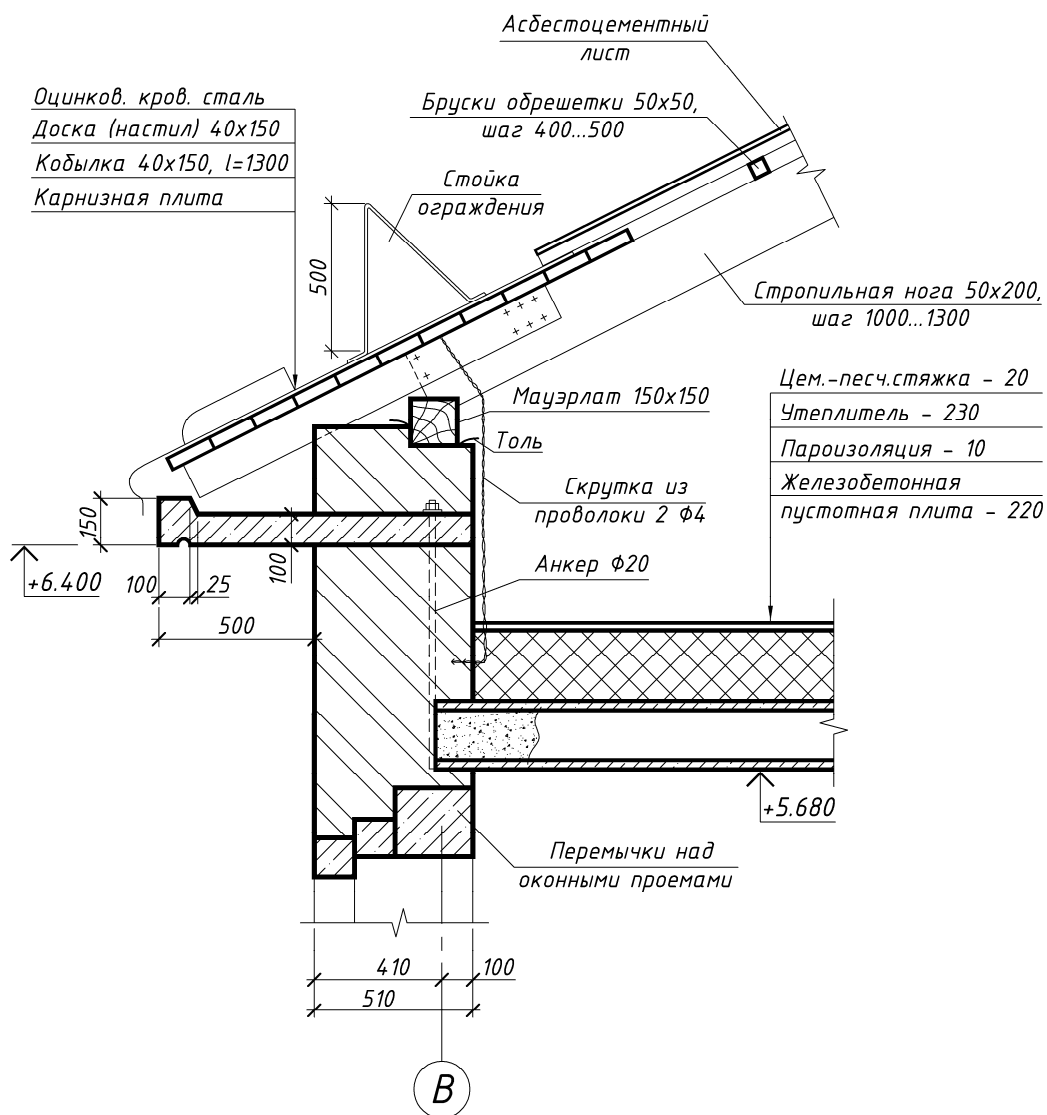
Узел сопряжения наружной стены с конструкциями покрытия и кровли жилого дома
